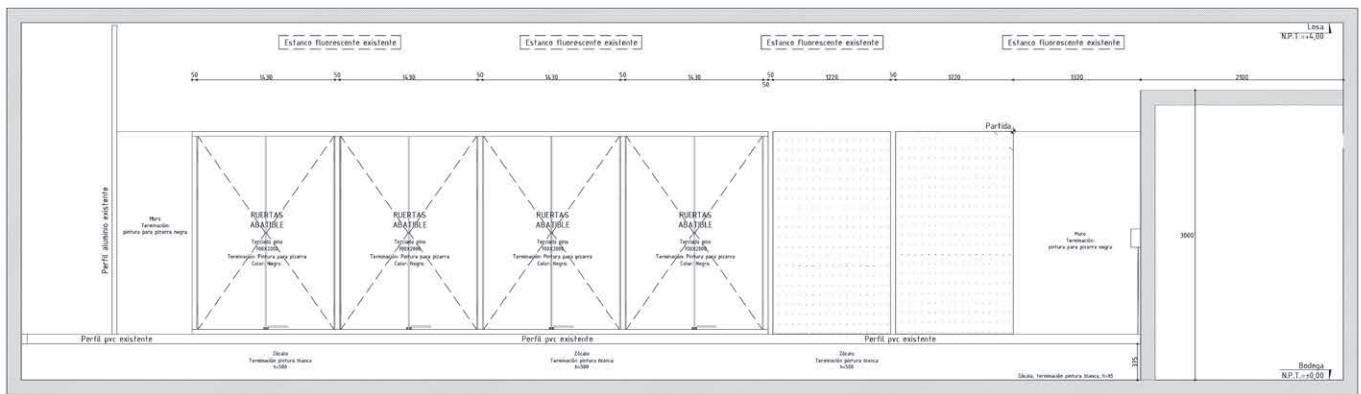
Alzado oriente. Fuente: Elaboración propia.
